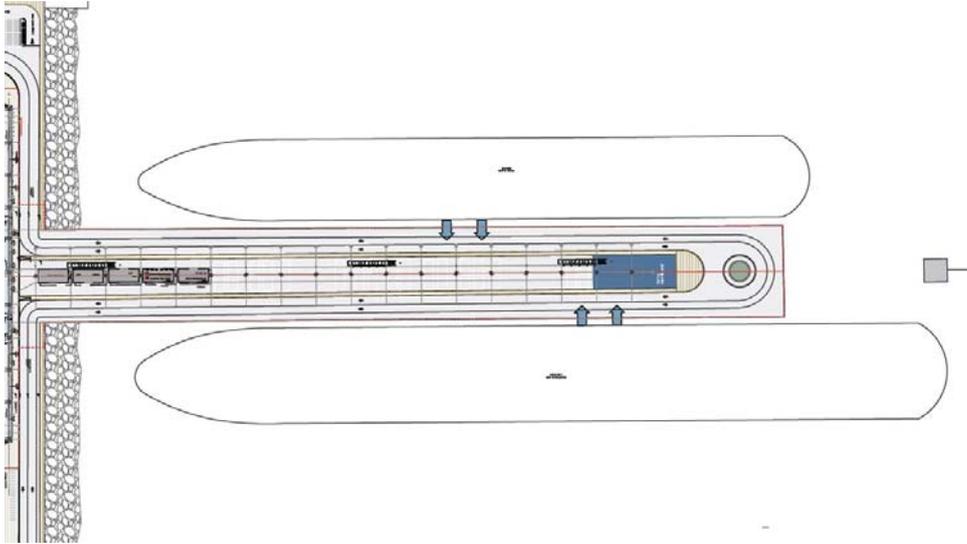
planimetria generale, Banchina crociere ed impronta delle navi (lato Est)
